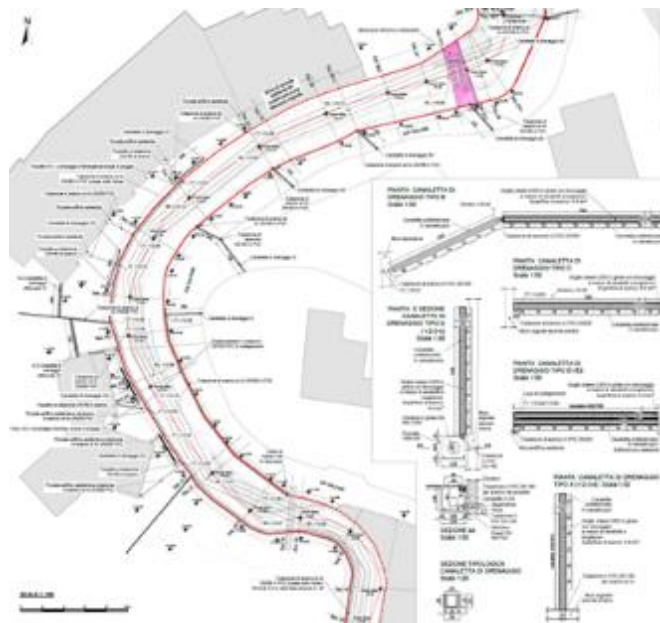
Stralcio della planimetria con posizione delle griglie di scolo
